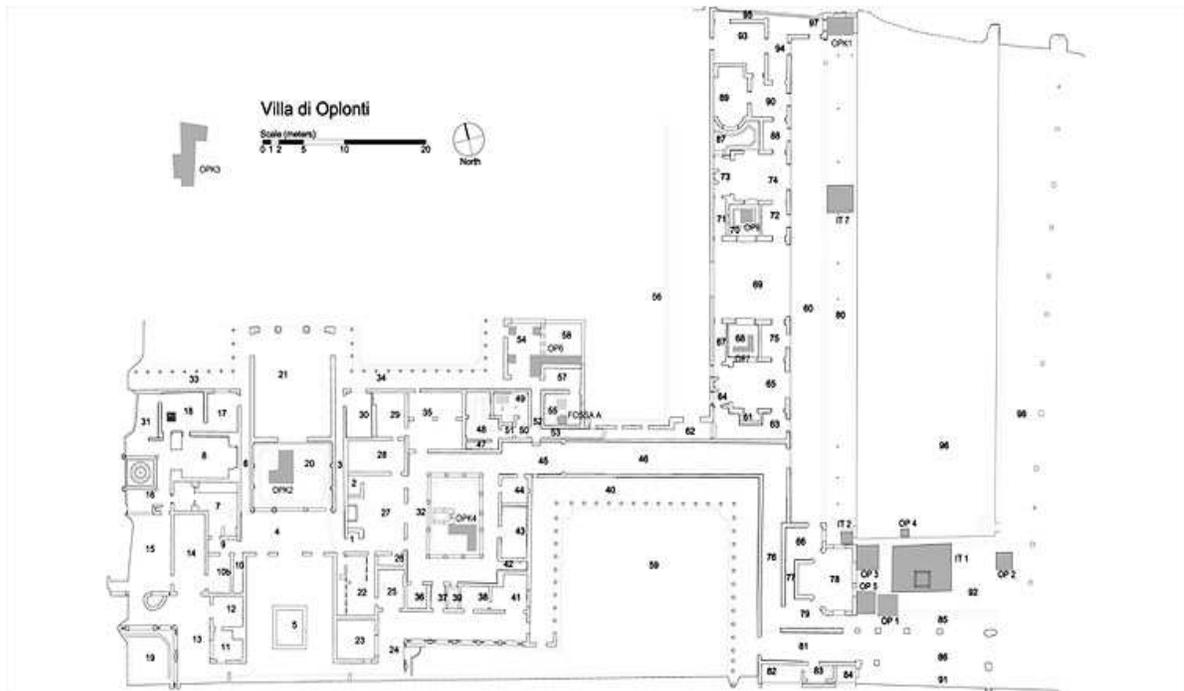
Planimetría general de la Villa de Poppea, excavada parcialmente ya que hay una carretera que pasa por la mitad. Sovrintendenza archeologica Pompei.
